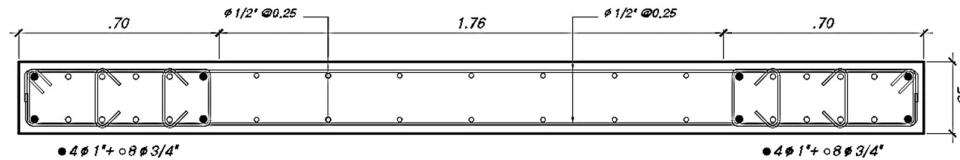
Distribución preliminar de acero de refuerzo en muro a diseñar. Fuente propia.
